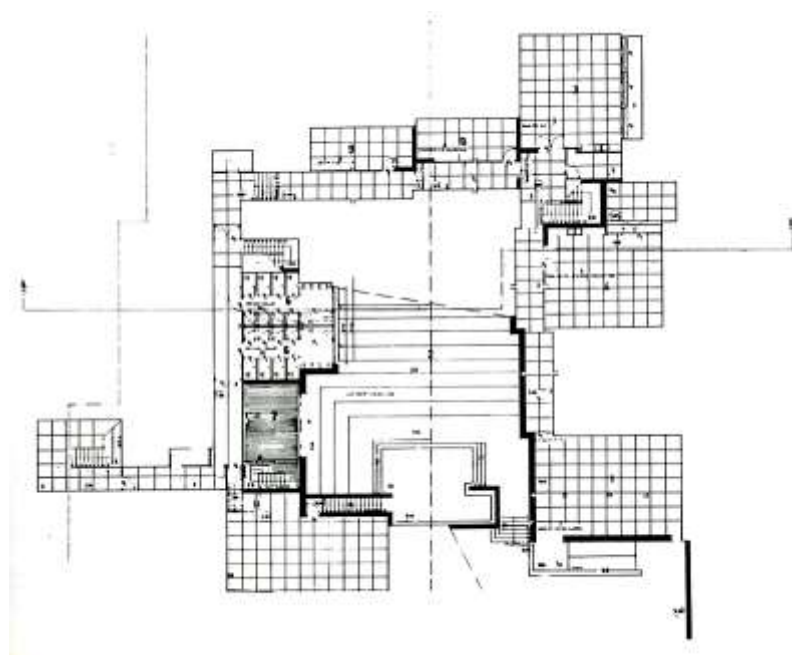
Planta do 1º piso - revista *Arquitectura* nº126, 1972, p.91
